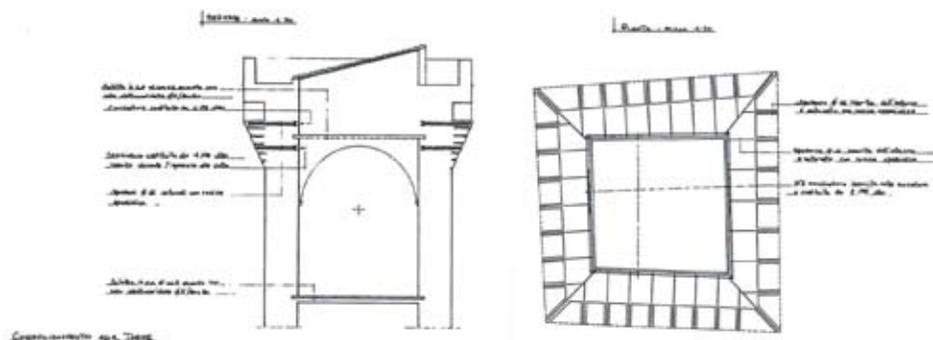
progetto strutturale dell'Ing. Mario d'Achille.
